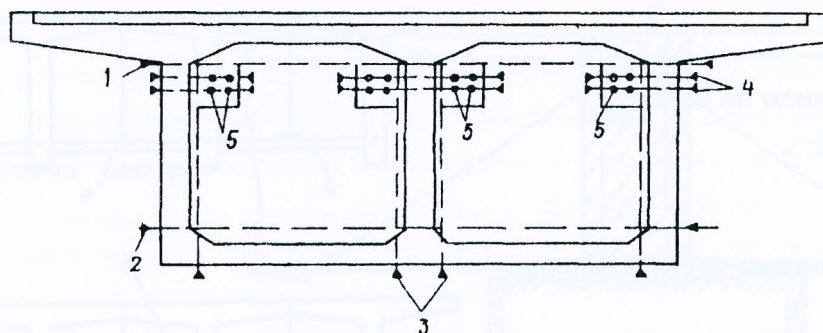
Схема усиления коробчатого пролетного строения: 1 – пучки под верхней плитой; 2 – пучки над нижней плитой; 3 – вертикальные пучки; 4 – анкеровка; 5 – дополнительное продольное армирование.
